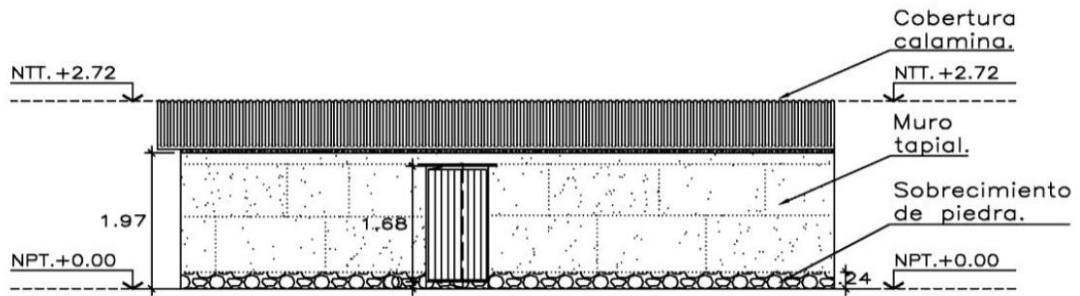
Vistas de elevación de la típica vivienda rural en Huancavelica
